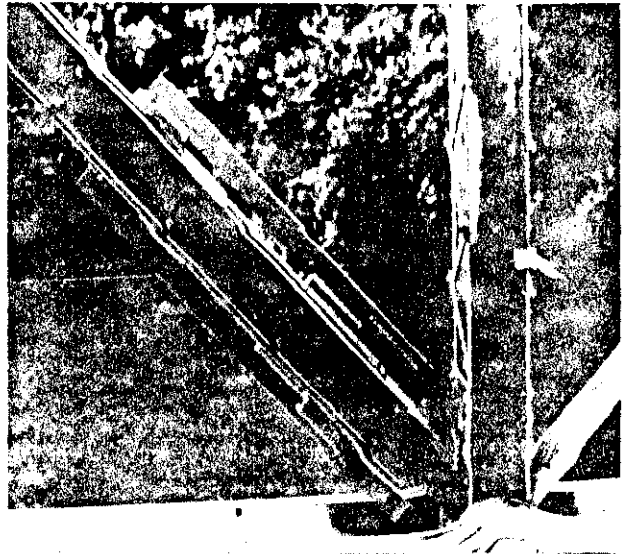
Diagonal (chapa e olhal) reforçada pela adição de perfis (U). Dispositivo para aplicação de força externa.
